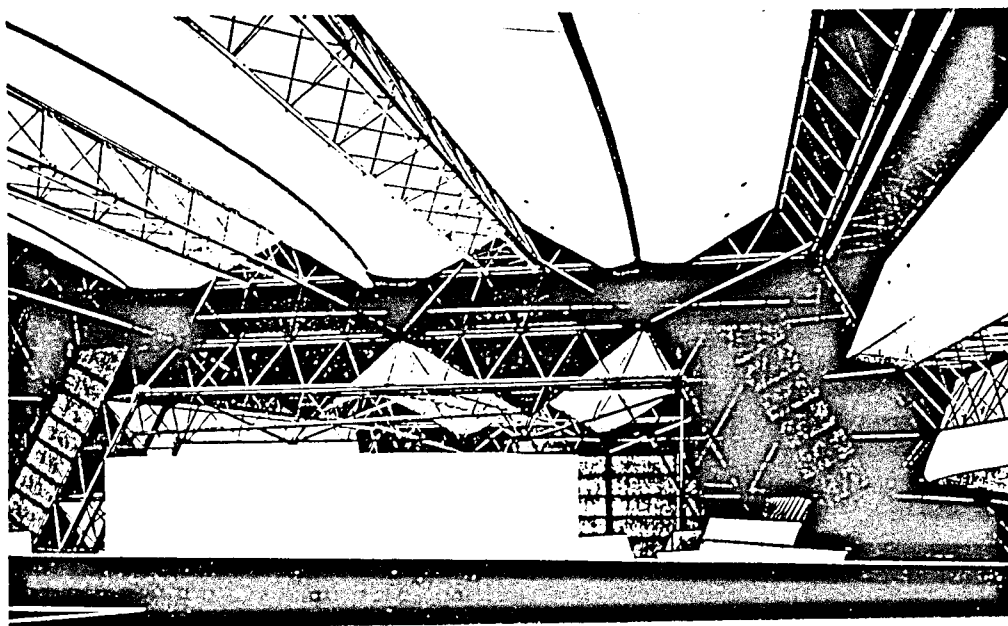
Construção de aço visível do interior do sector "Industria y Manufacturas", na Feira Suíça Expo 1964
